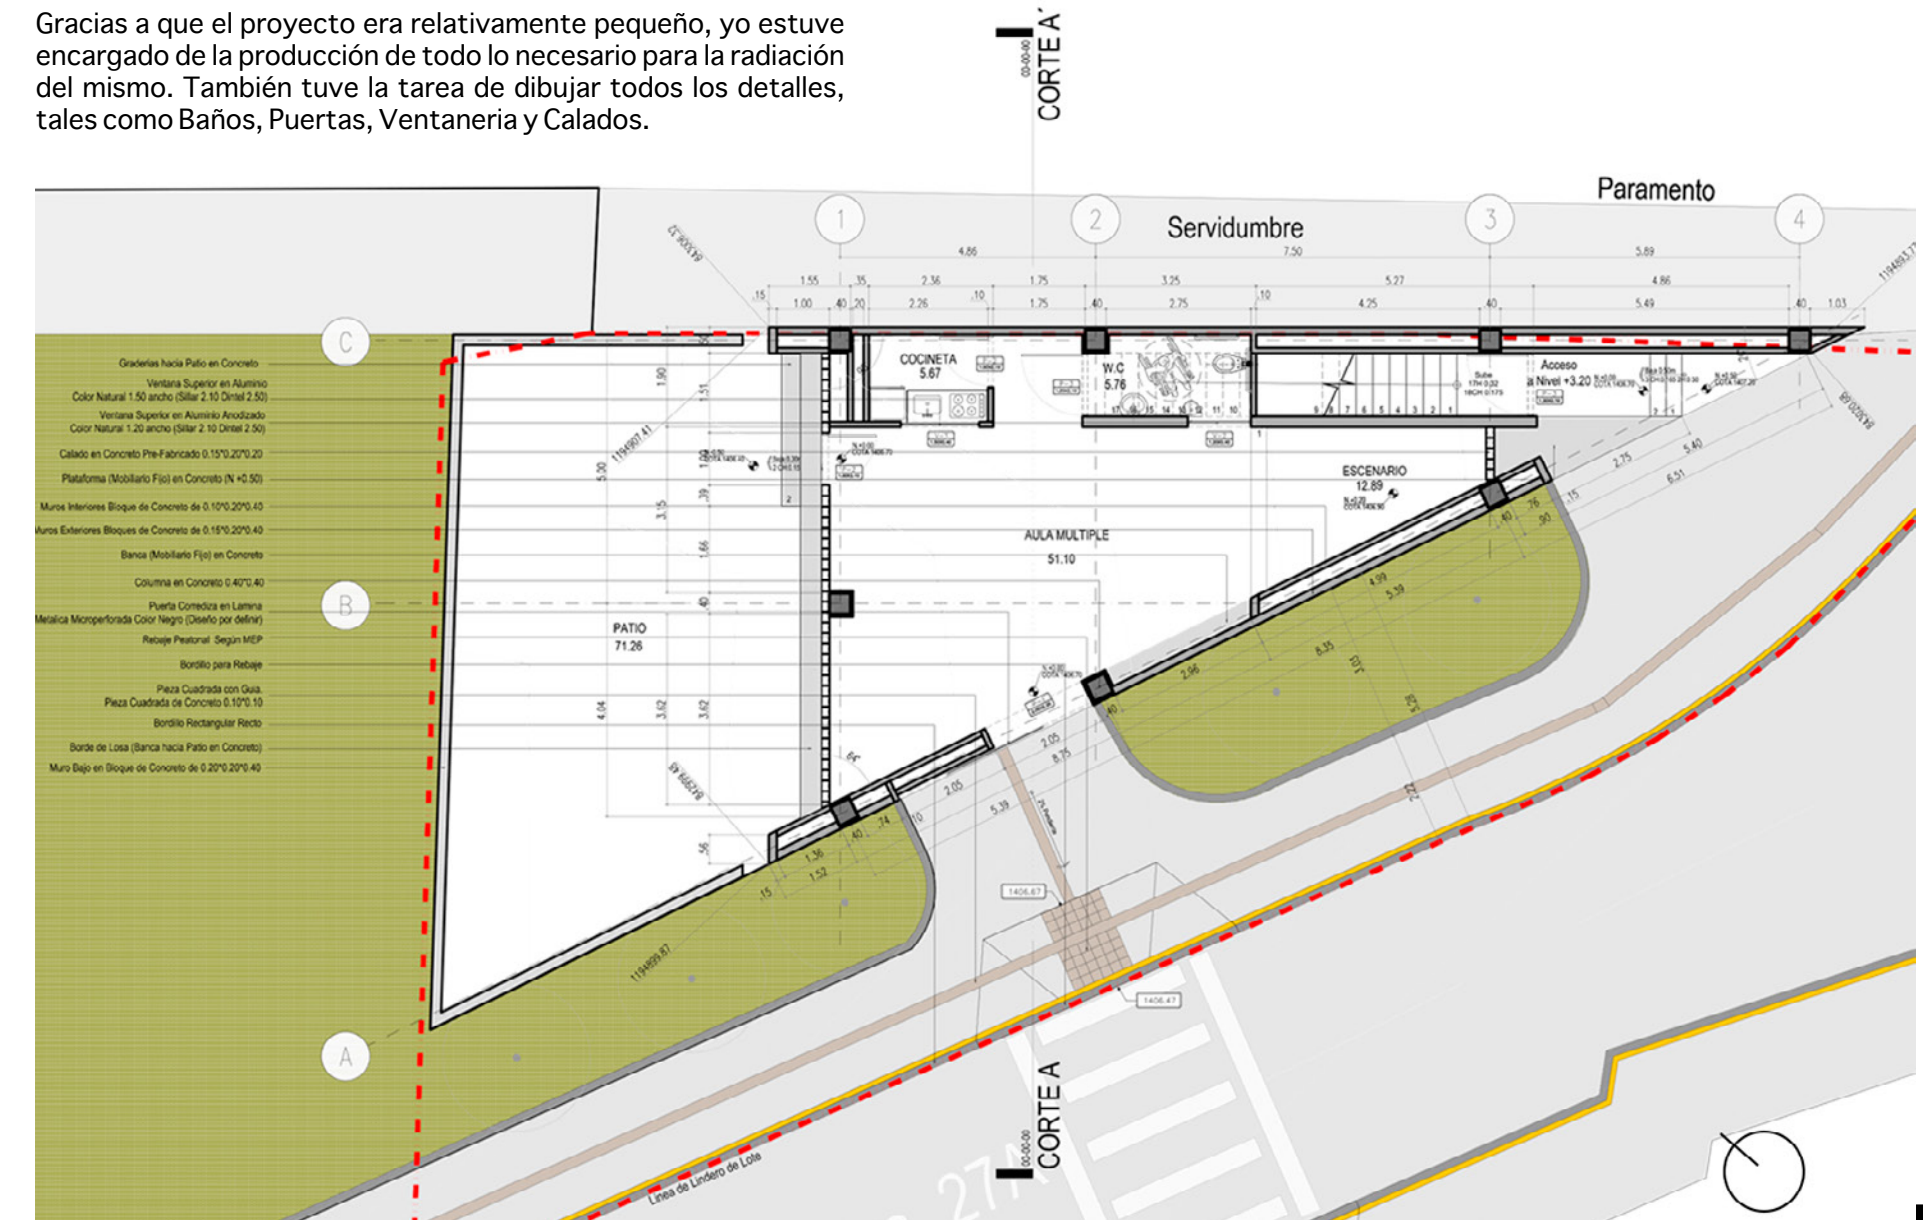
Planta de Acceso. Elaborado por: Equipo de diseño A+U.
